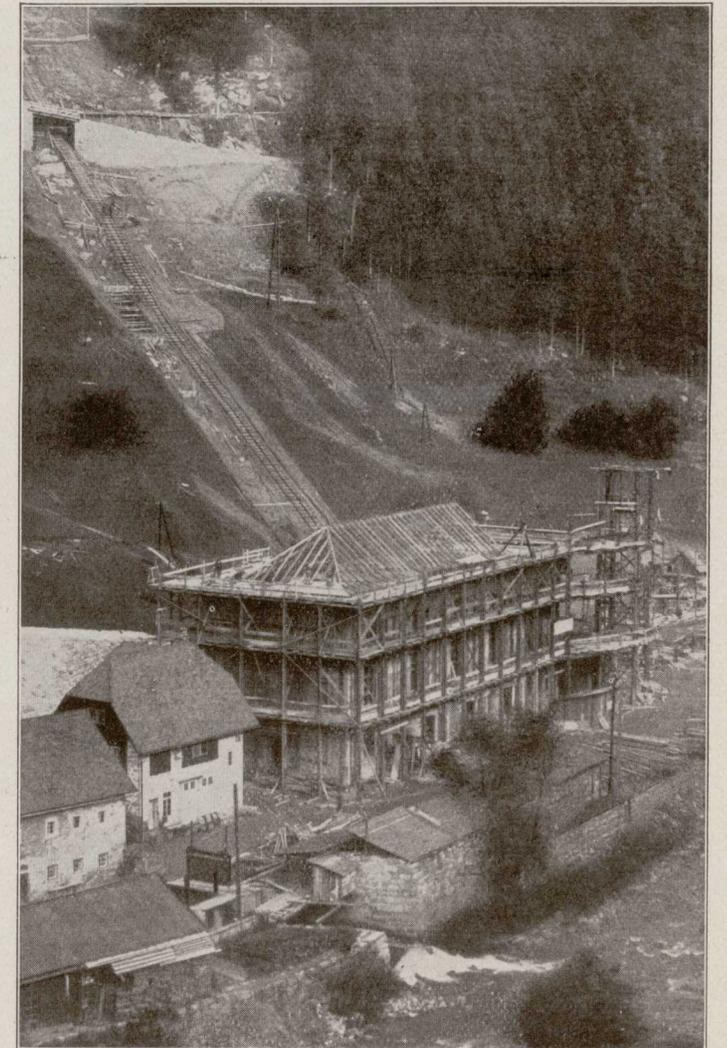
Bau des Maschinenhauses, Oktober 1923
